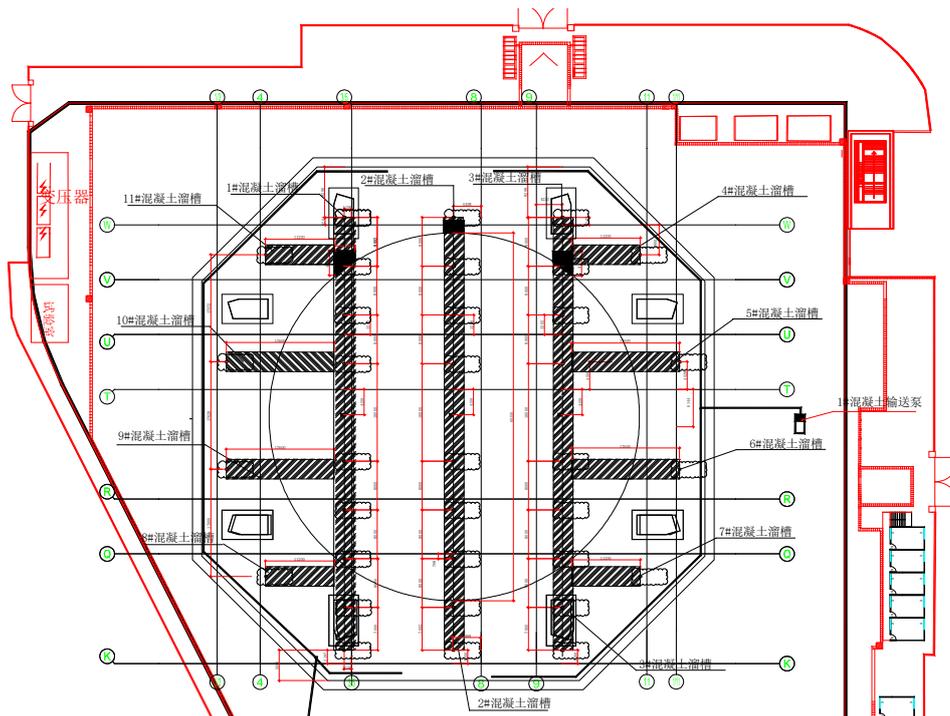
溜槽脚手架平面布置图（平安金融中心）
